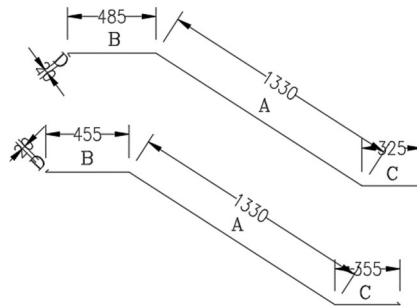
38: Potongan A-A Tangga Tipe 1
